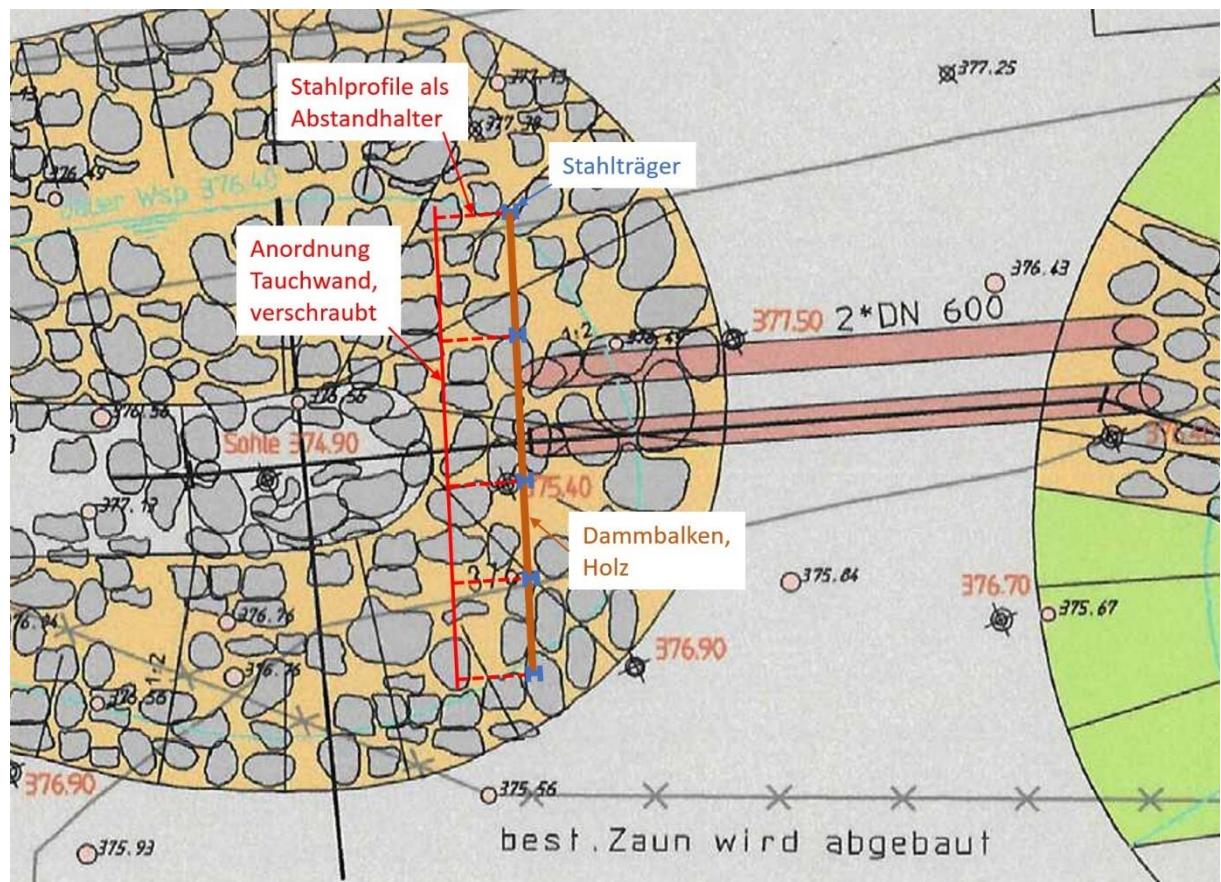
Skizze Lageplan Überlauf und Tauchwand an Absetzbecken
